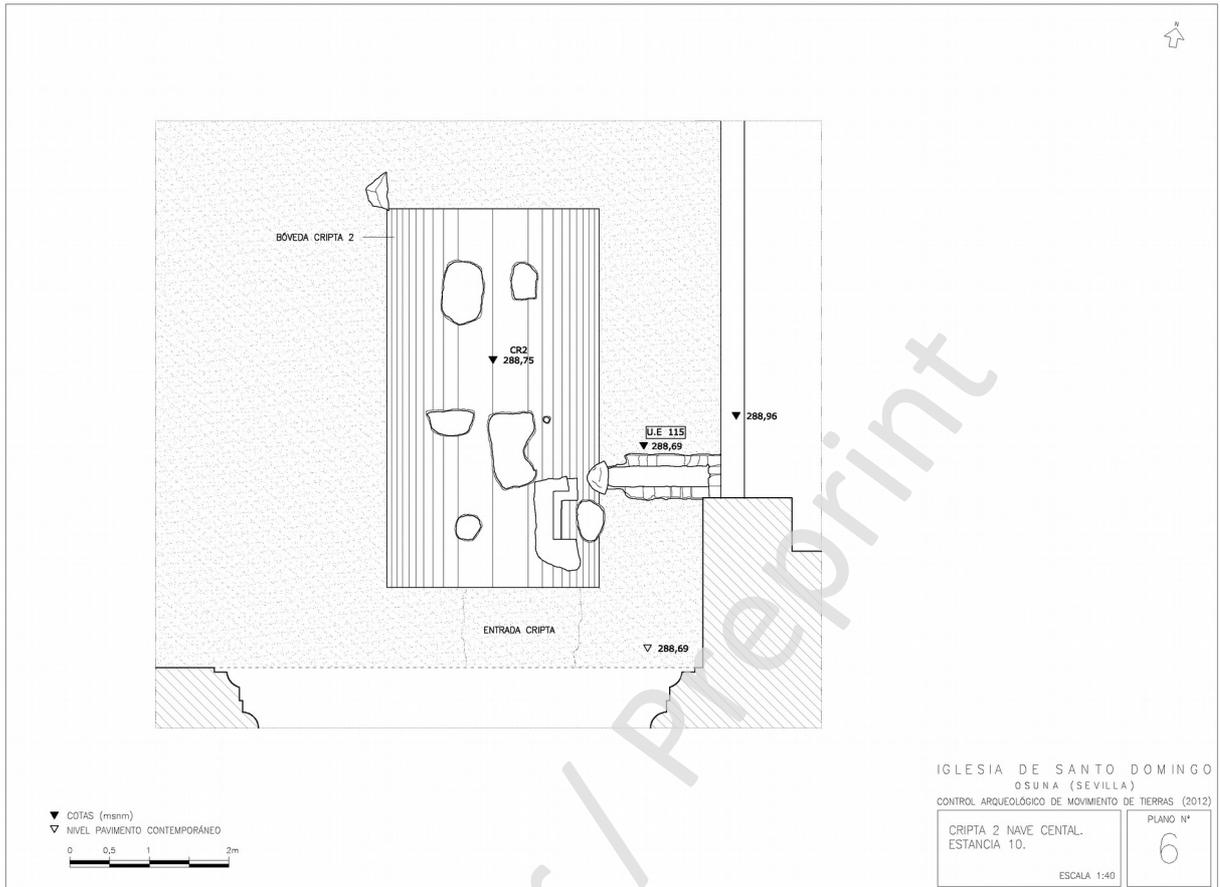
Plano de la cripta documentada en el proceso de rebaje de la nave central
